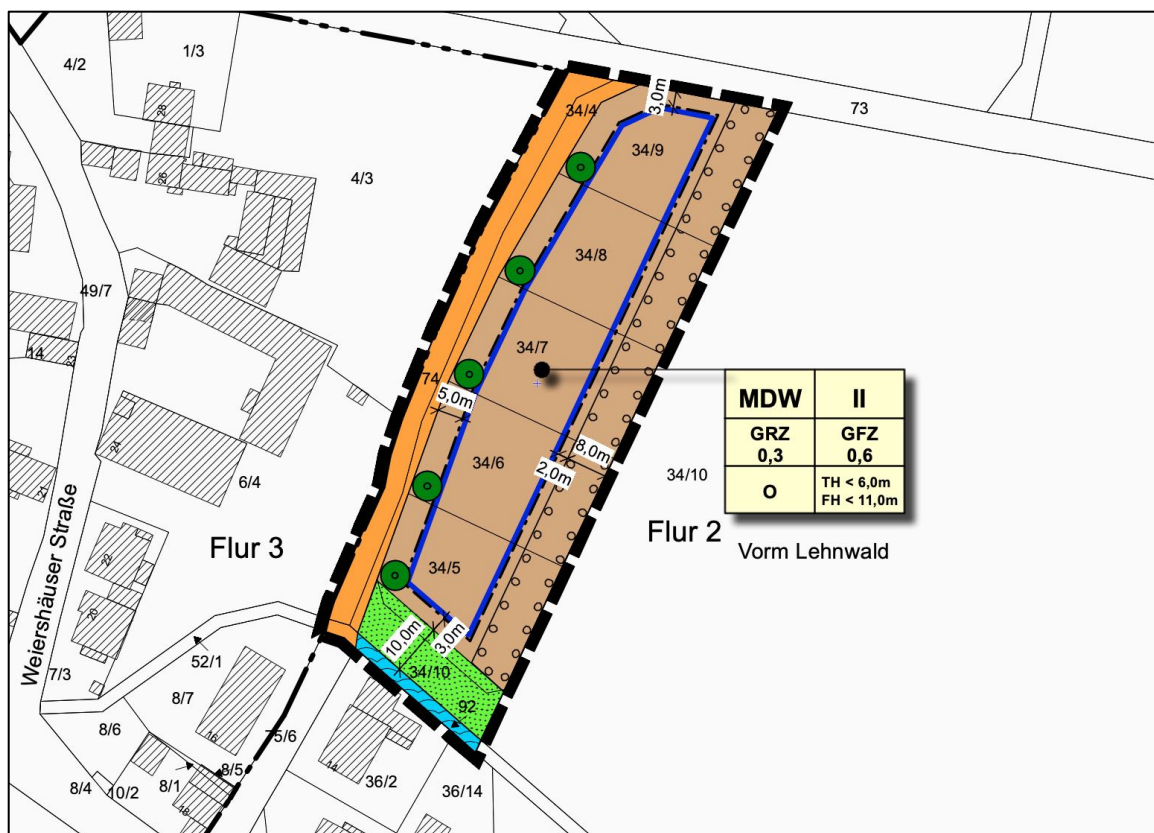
Bebauungsplan „Vorm Lehnwald“ - Vorentwurf Planteil
